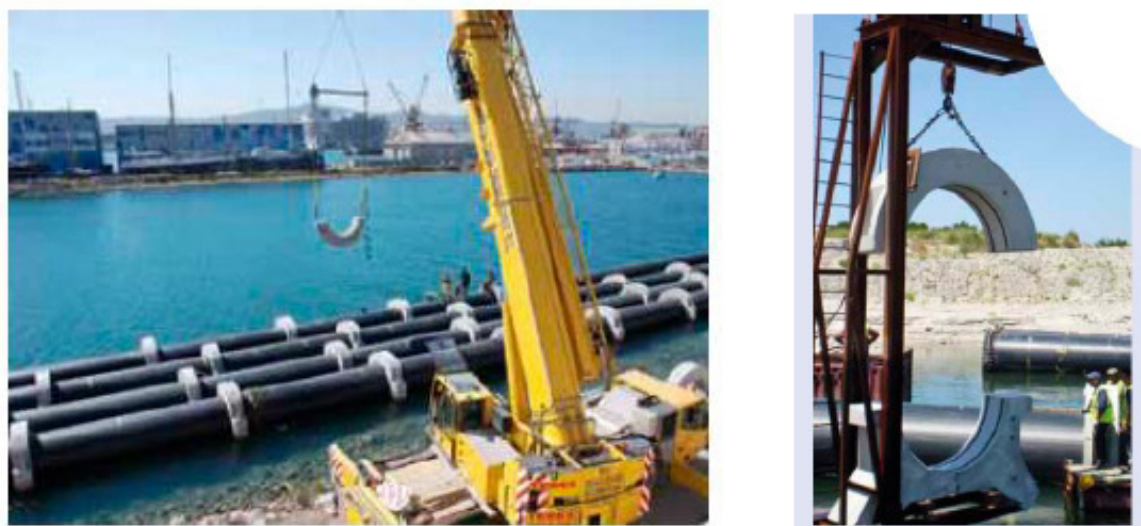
Installation de poids en béton à l'aide d'une grue (à gauche) et d'un cadre (à droite)
